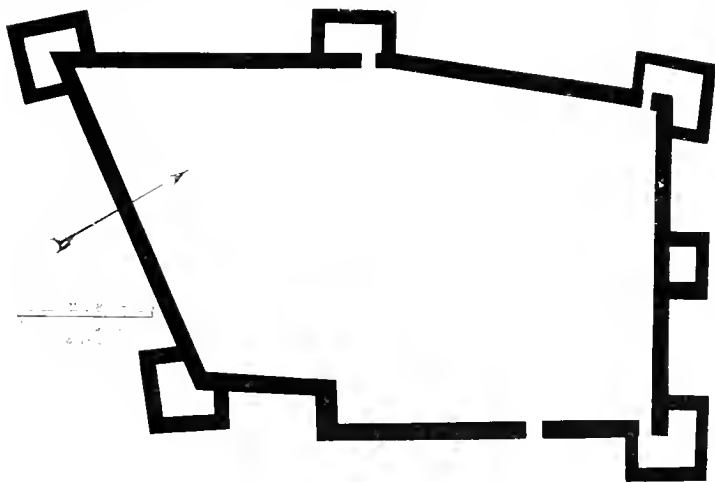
TELL ZAKARIYA. Plan de la citadelle. D'après BRISS et MACALISTER, *Excavations...* pl. 3.
